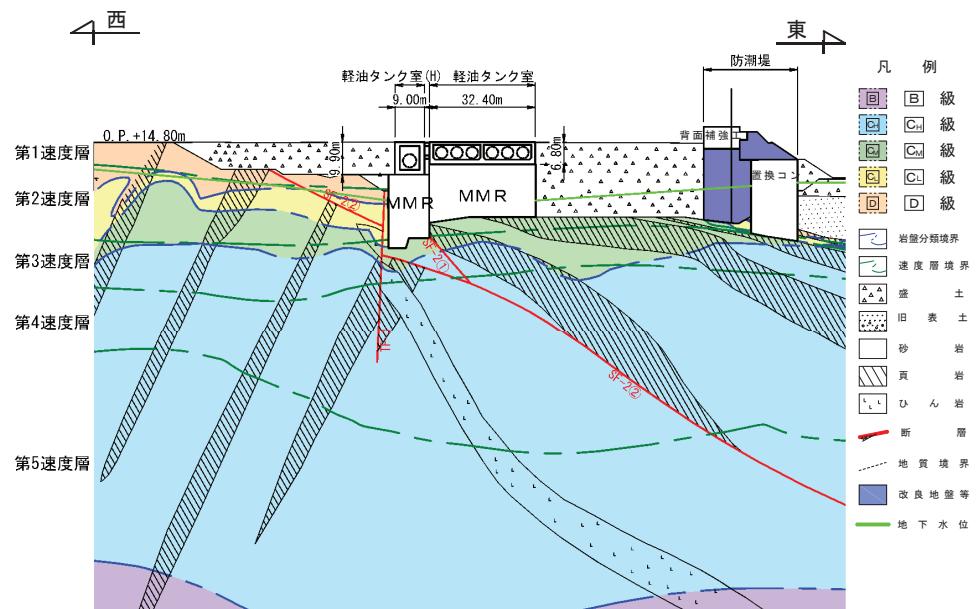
軽油タンク室 (H) 地質断面図 (A-A)
